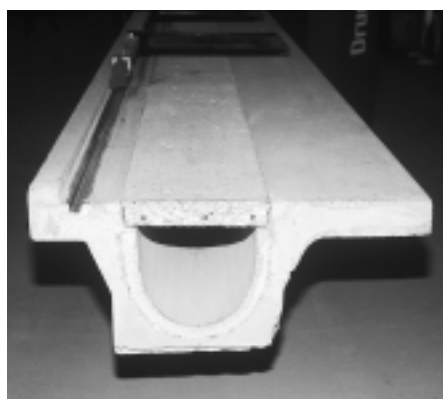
Les canaux d'évacuation présentent généralement peu de pente. Il vaut donc la peine de prévoir une conduite de rinçage fixe; pour des tubes de drainage, une telle conduite est obligatoire.
